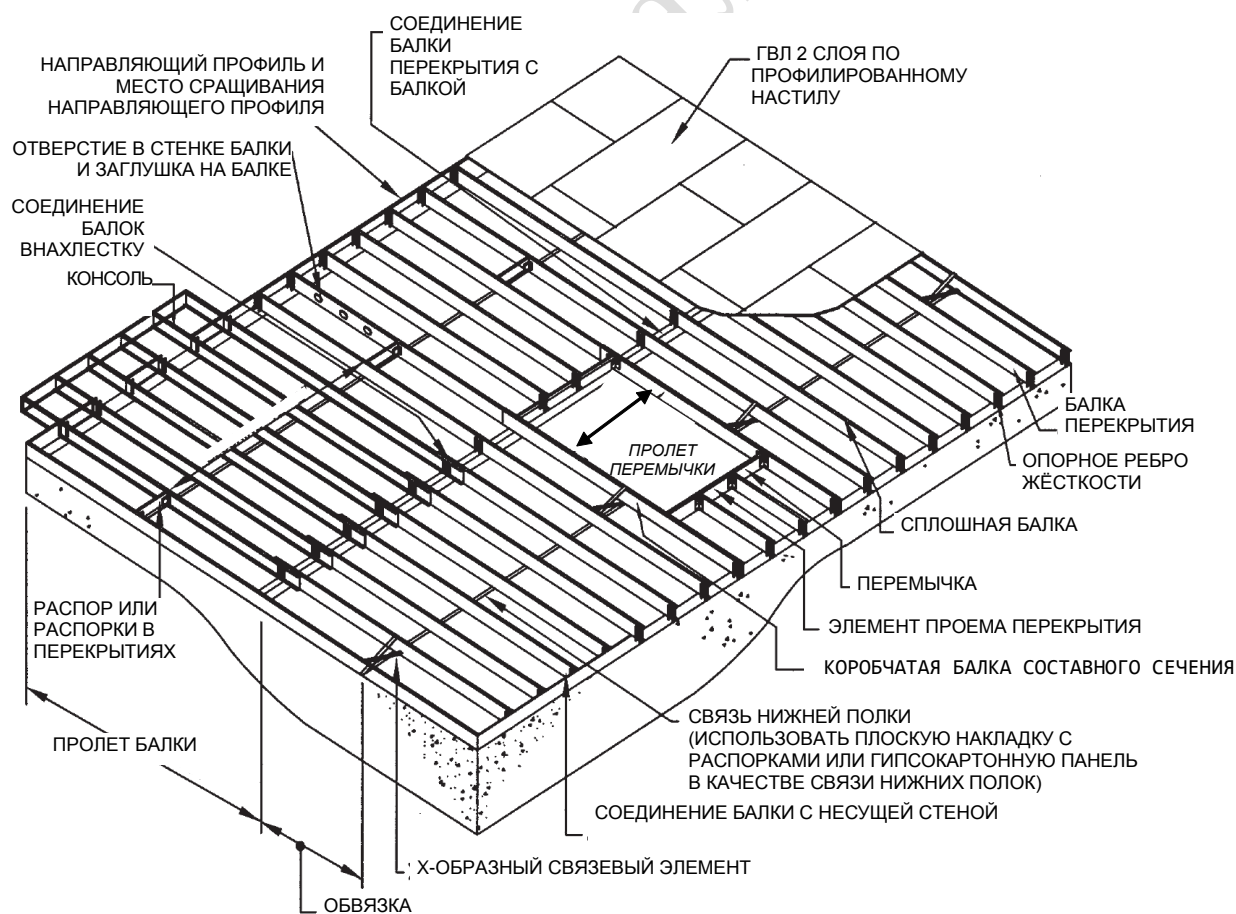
Элементы стальных конструкций междуэтажного перекрытия
